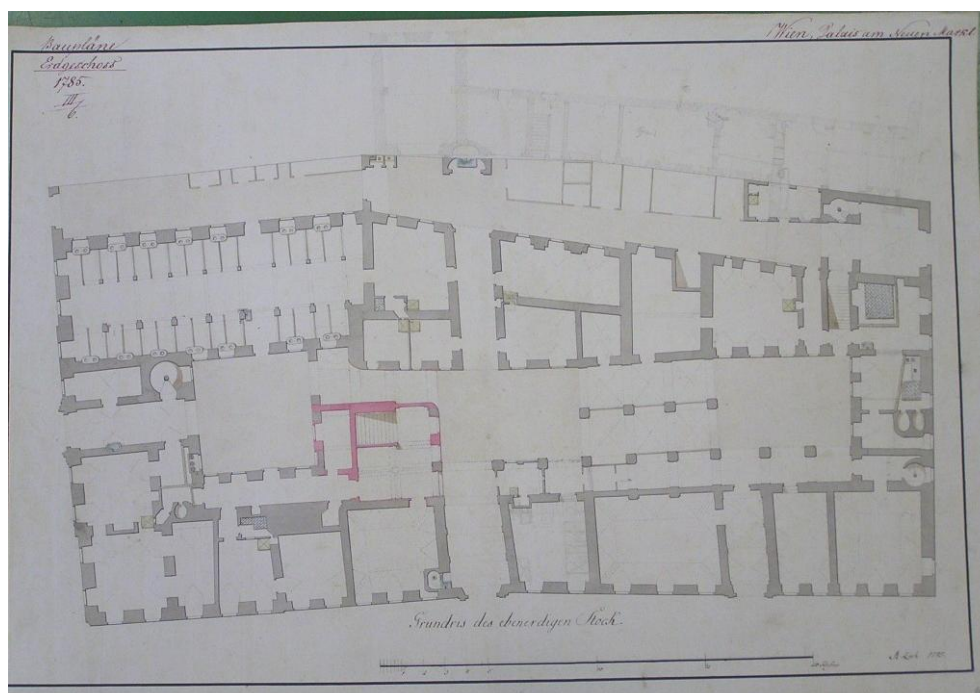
Das ehemalige Stadtpalais Schwarzenberg, Erdgeschossgrundriss III 6, signiert Andreas Zach und datiert 1785.
